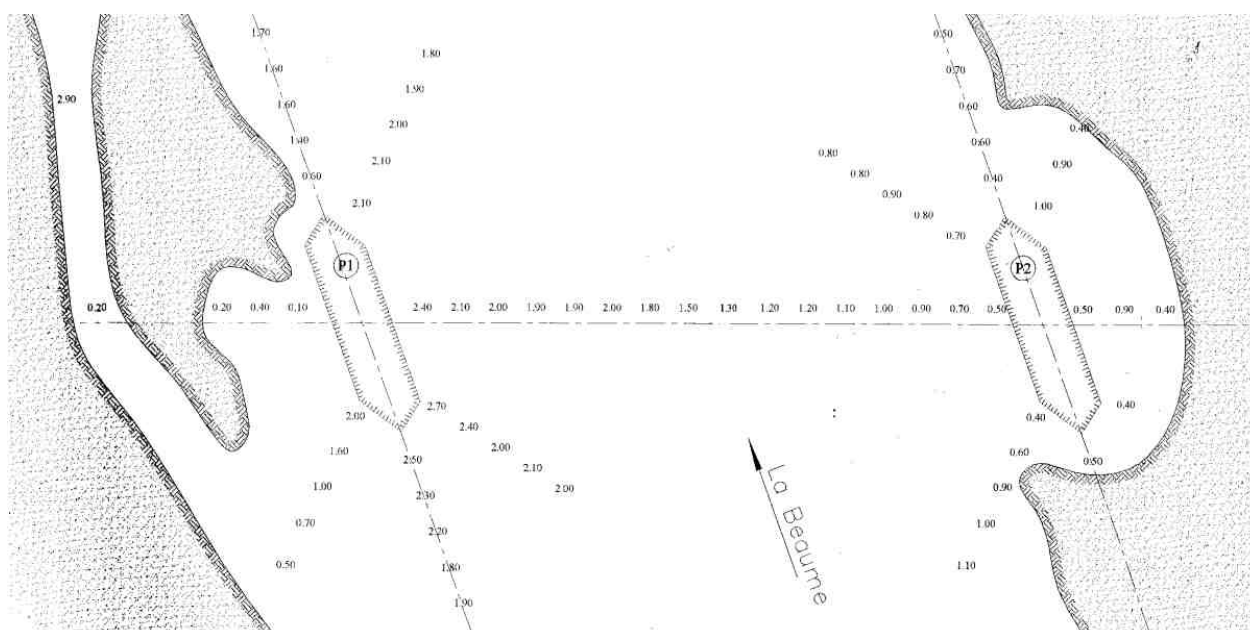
Vue en plan des piles de l'ouvrage (CG, 2008)
